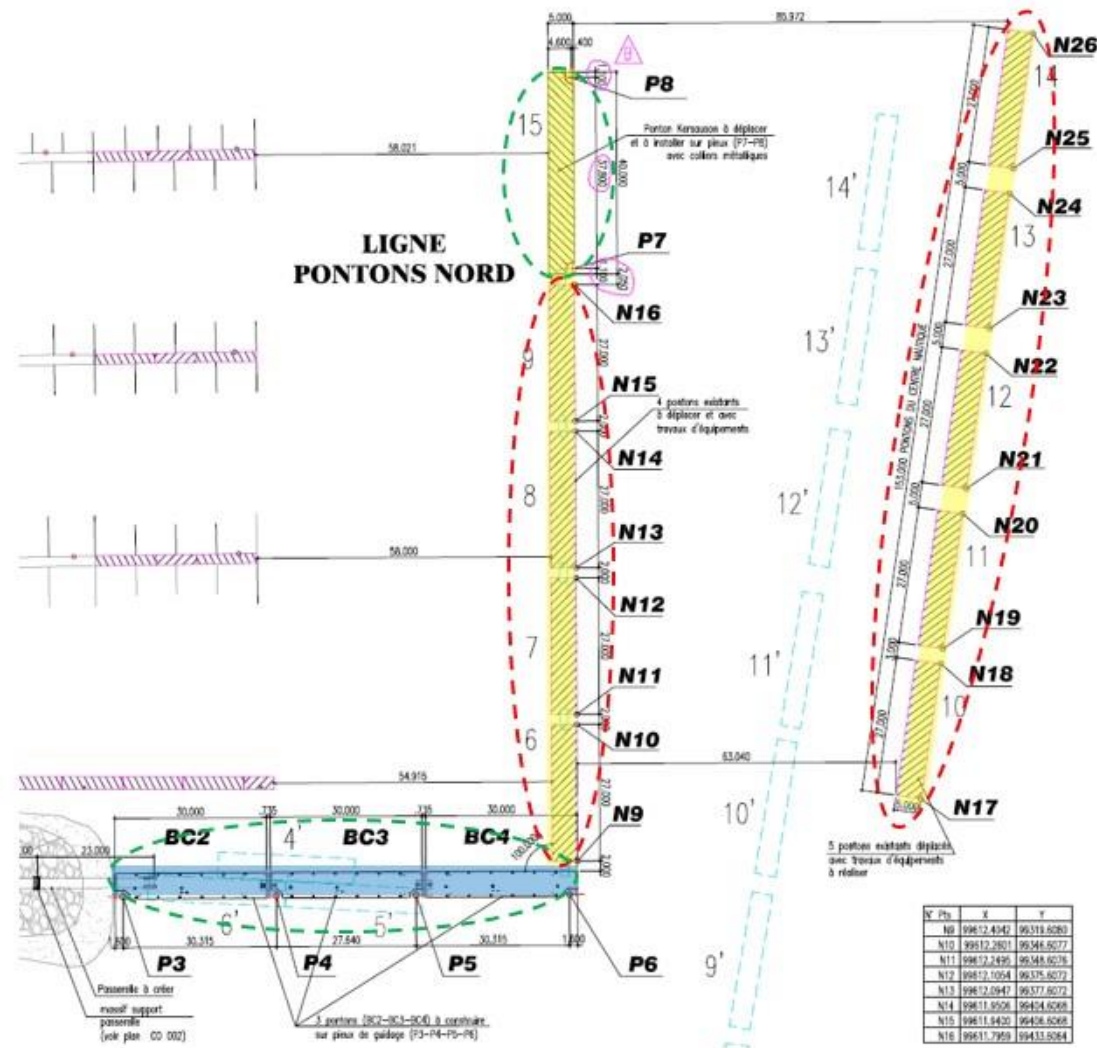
Plan masse état existant (source : Ingérop, mars 2023)
